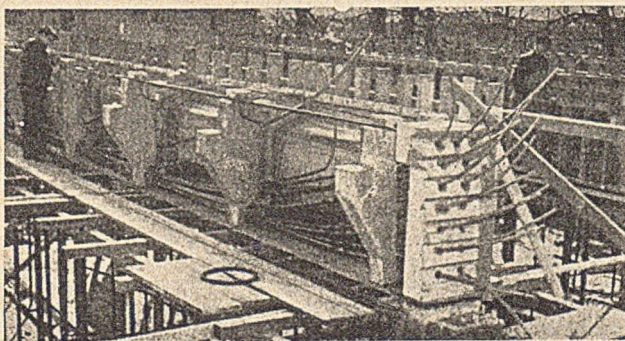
Bauzustand nach Einbau der Fertigbetonteile.
